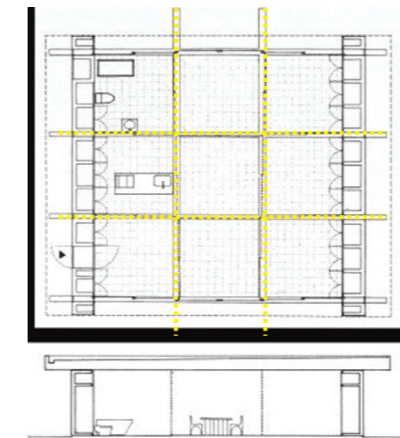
, Planta y sección nine square grid house, Shigeru Ban, 1997
